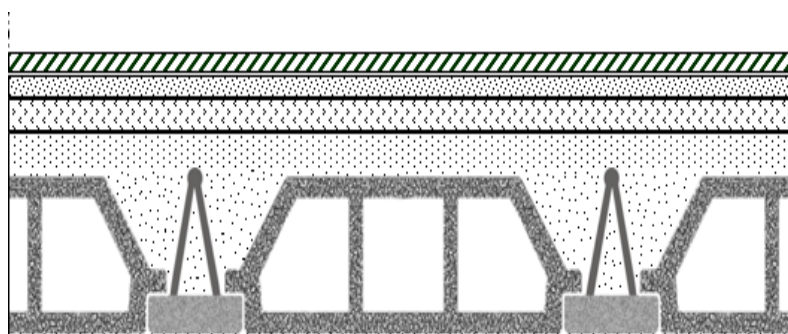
Coupe verticale du plancher étage courant à corps creux
